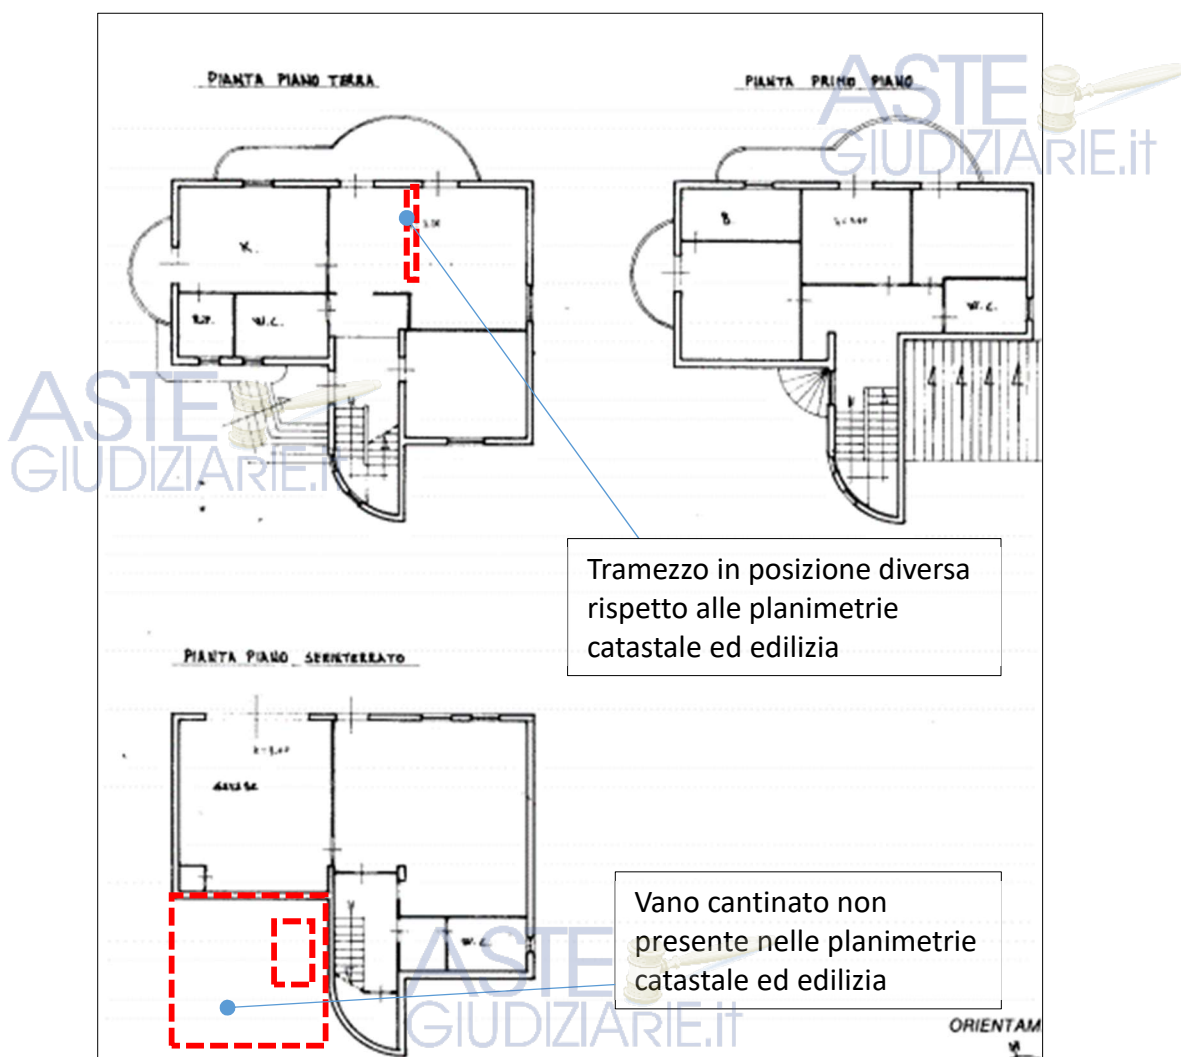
Differenze planimetria catastale rispetto a quello di rilievo del fabbricato (lotto 5).
